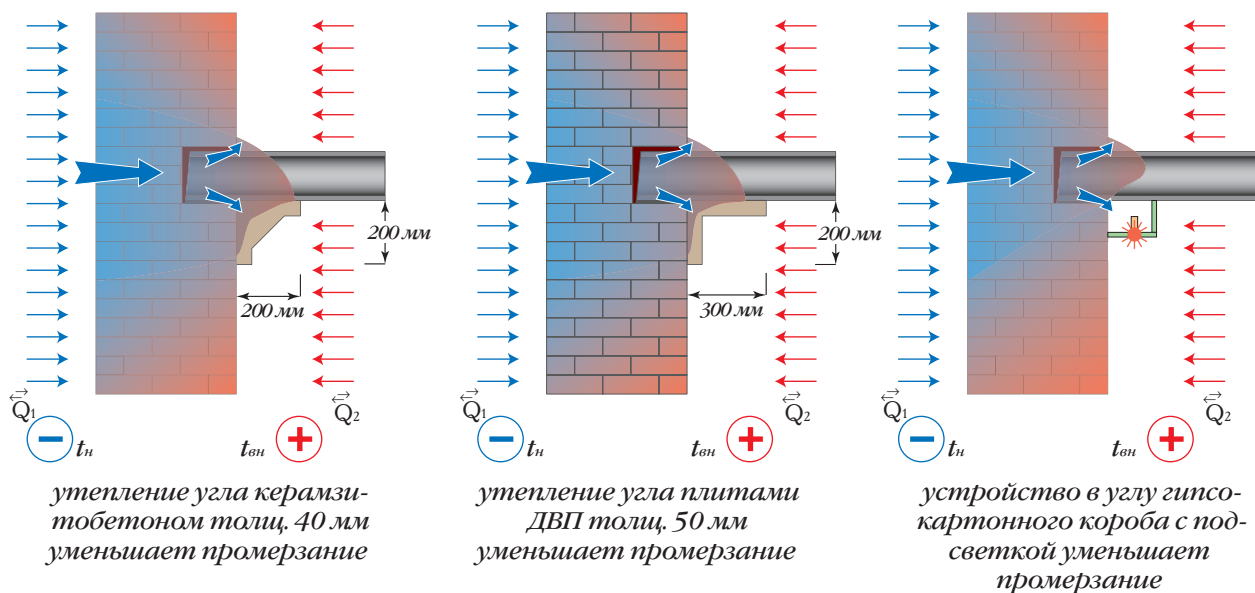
Утепление угла образованного стенами и плитами перекрытия
